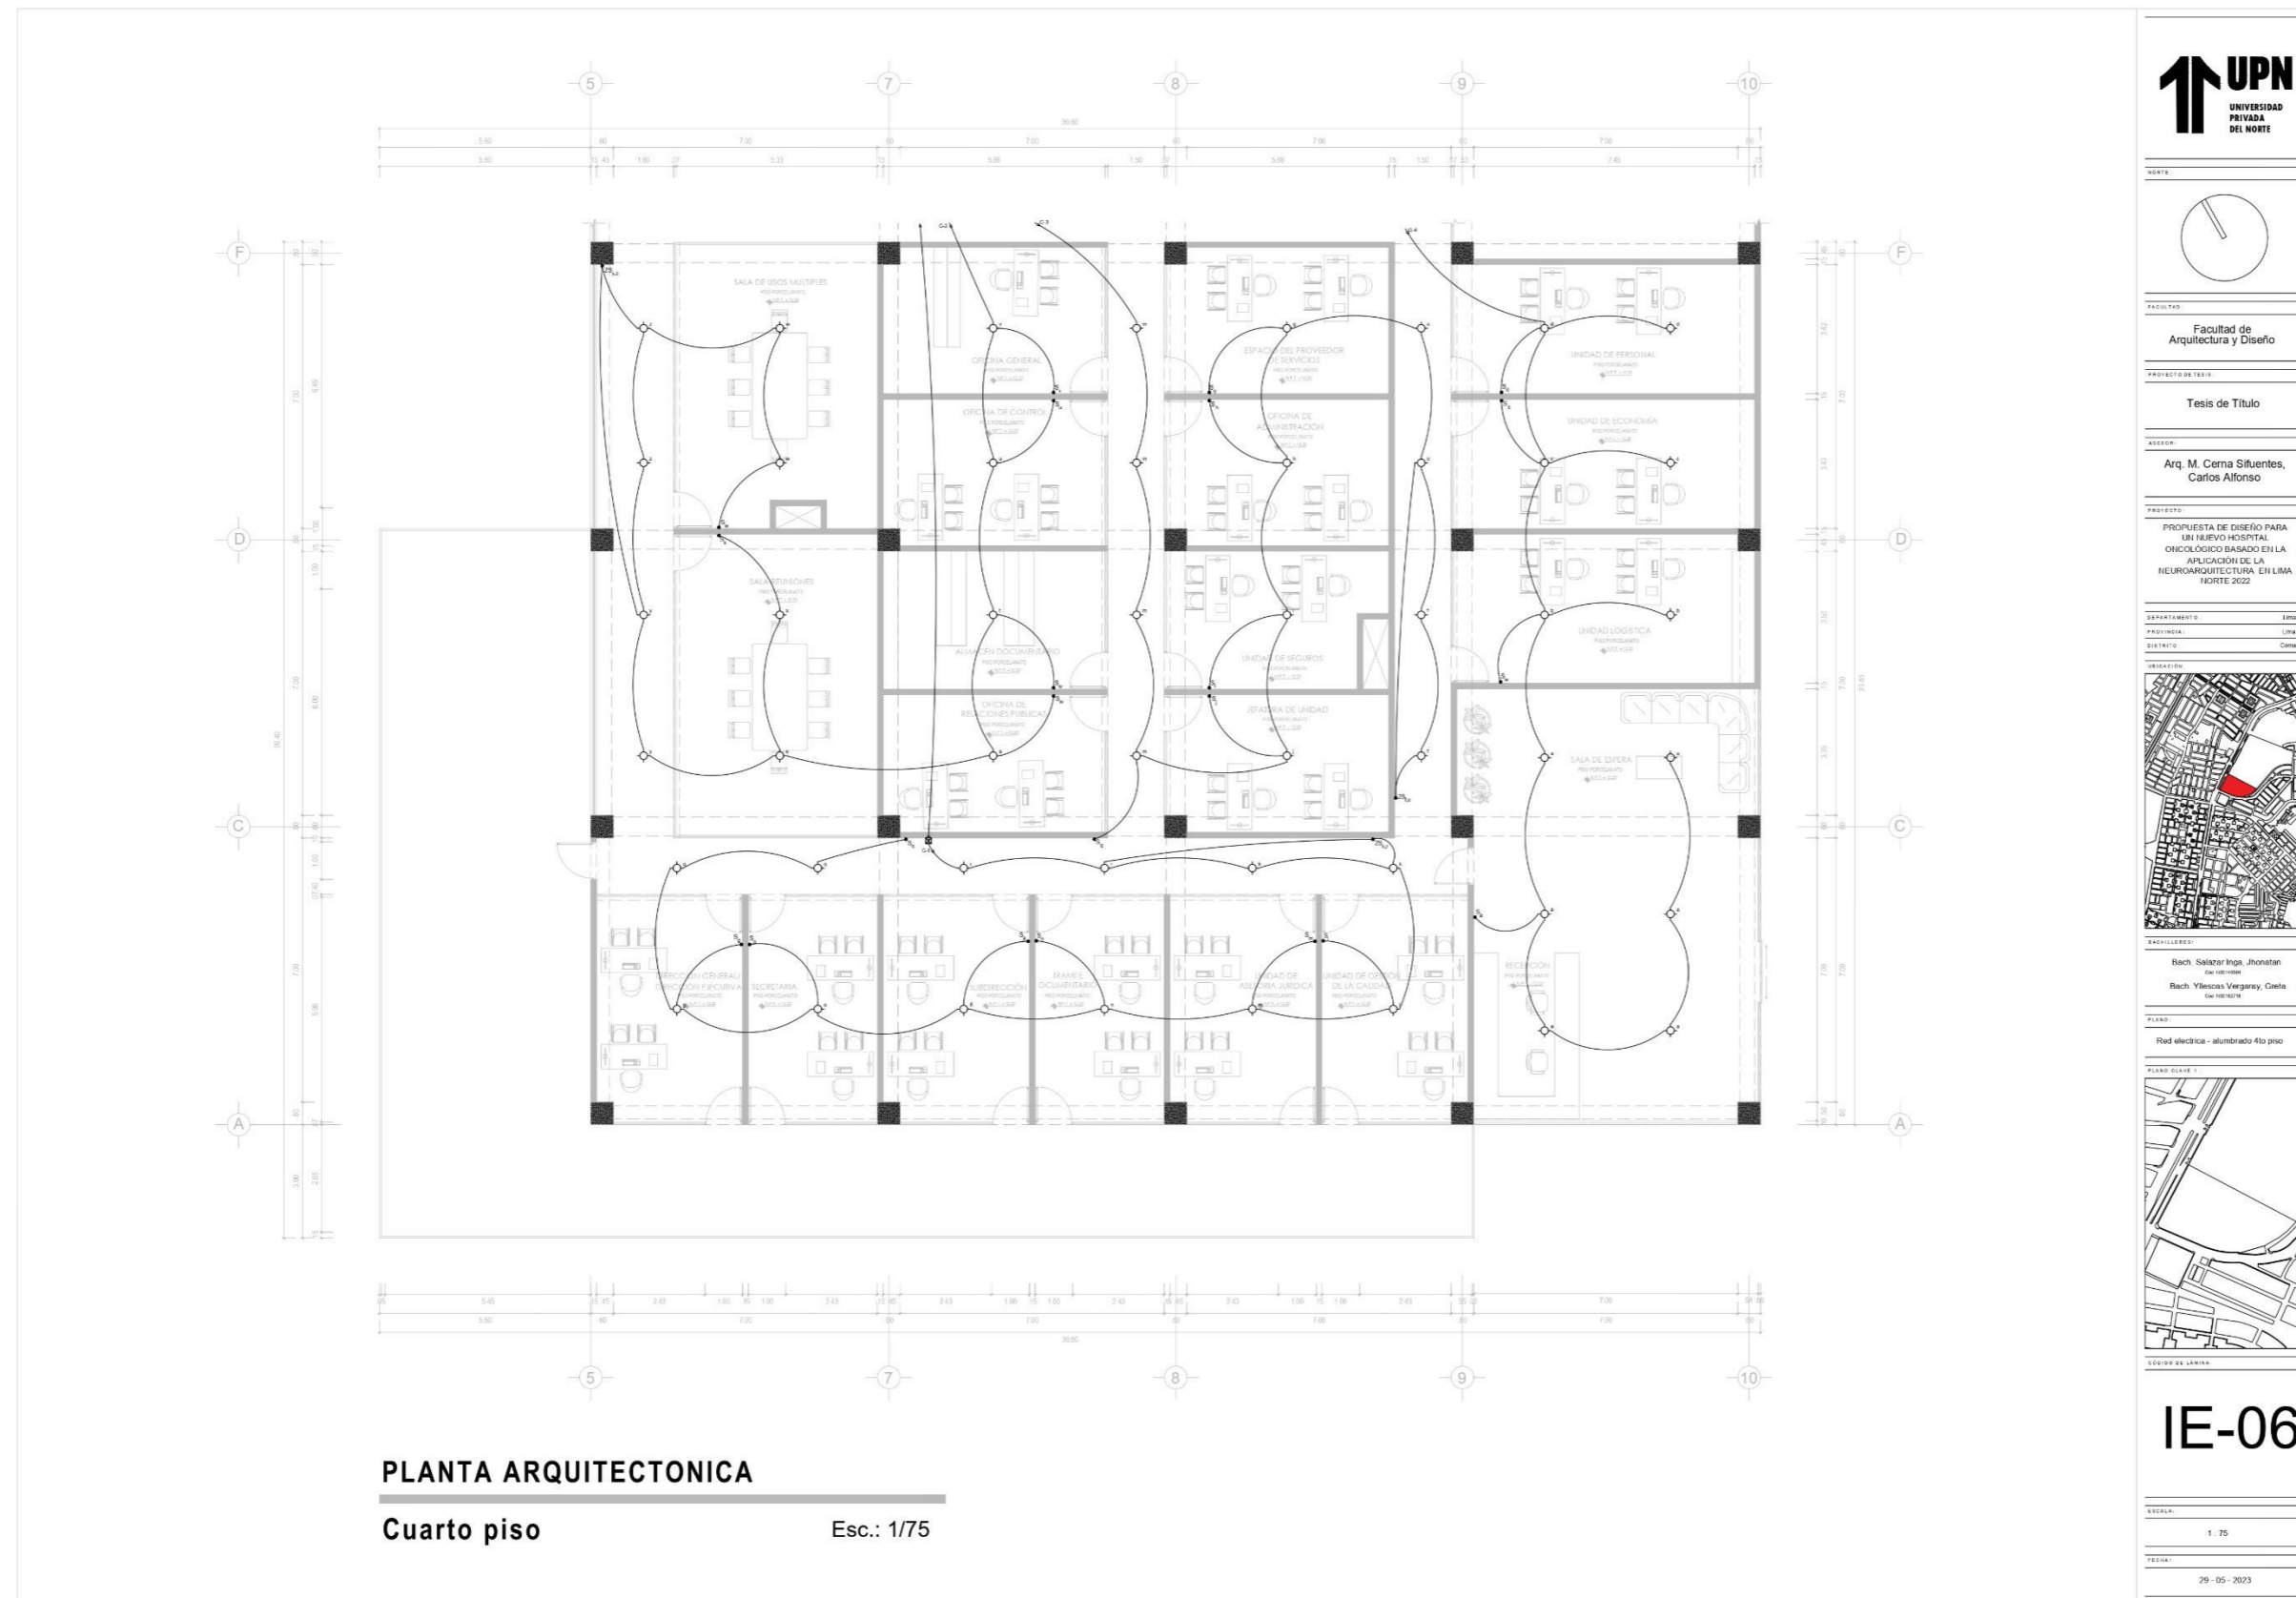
Instalaciones Eléctricas – Alumbrado nivel N°4 del sector cuadrante Esc: 1/75 (Fuente: Elaboración propia de los coautores)
